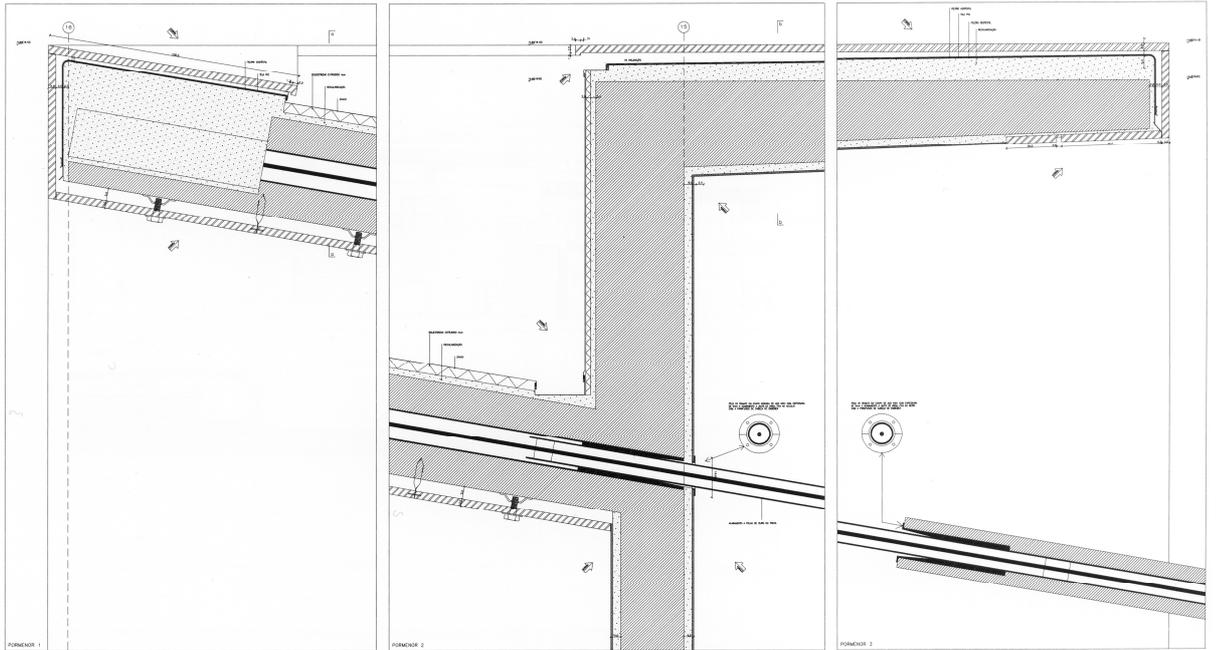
Detalles de la vainas de acero en el Pabellón de Portugal para la Expo de 1998 (Álvaro Siza, Arquitecto)¹⁰.
